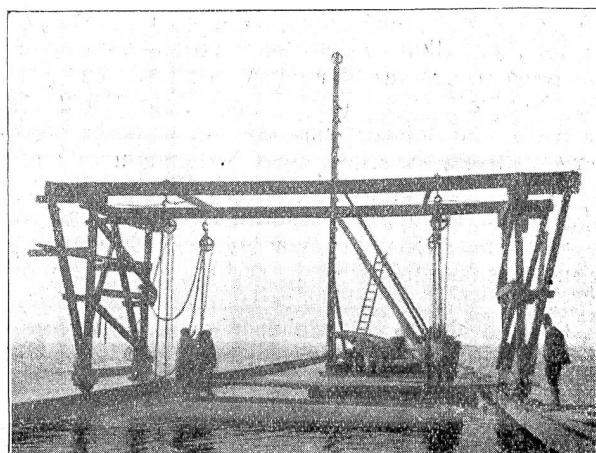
Laufkran mit Betonelement, vor dem Absenken.
